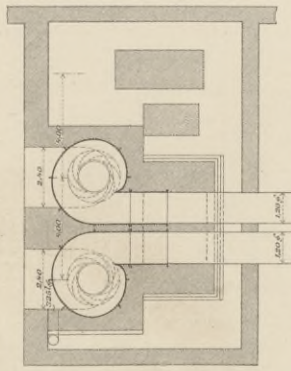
Schnitt durch das Grundmauerwerk des Maschinenhauses und der Pumpen.
